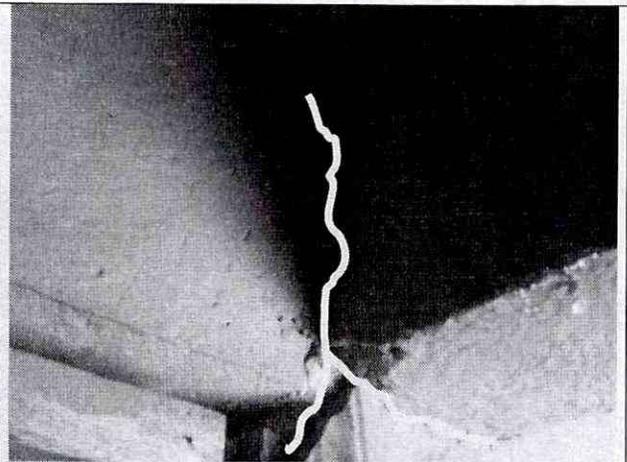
Se observa el agrietamiento en la uniones de los elementos estructurales de la vivienda ubicada en la Carrera 18 No. 79-12 Sur *(Fotografía tomada el 27-10-11).
